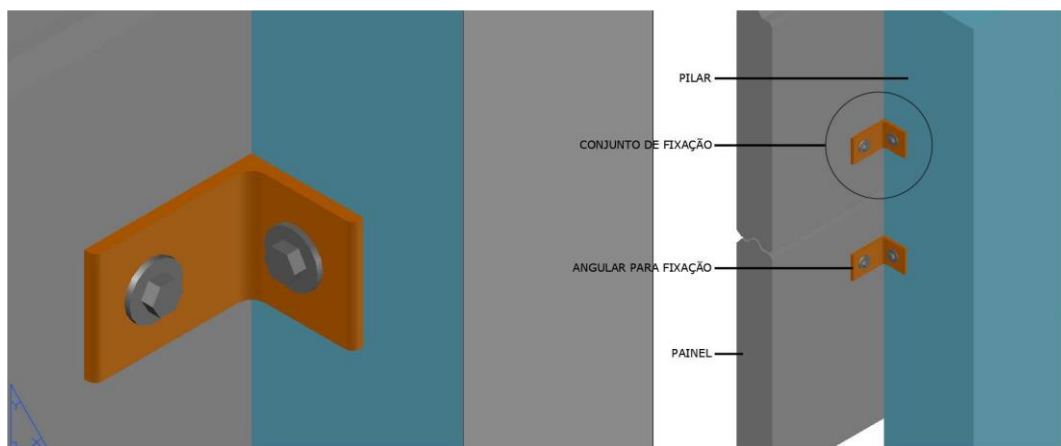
Pormenor de fixação de um painel pré-fabricado com um pilar “in situ” (José Rui Pinto,2021)
